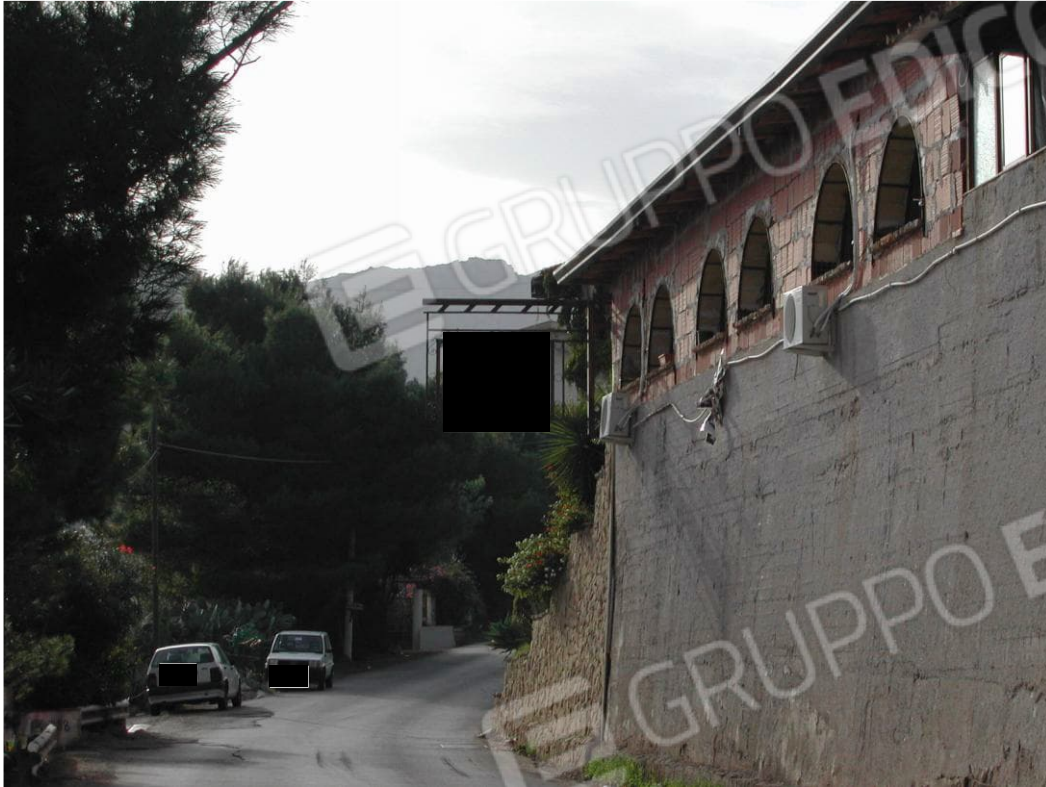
Vista della pizzeria in adiacenza all'edificio, sul prospetto principale.
